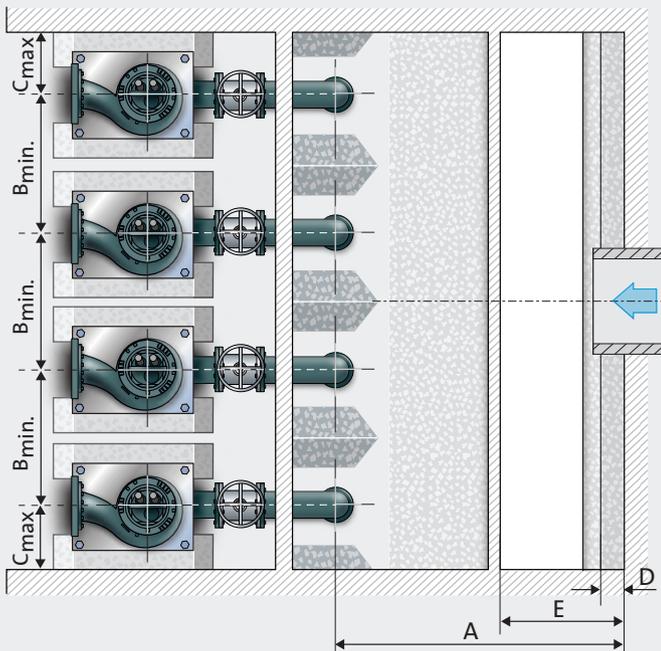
Draufsicht auf den Pumpenraum mit Saugleitungen und Zulaufverteilern
